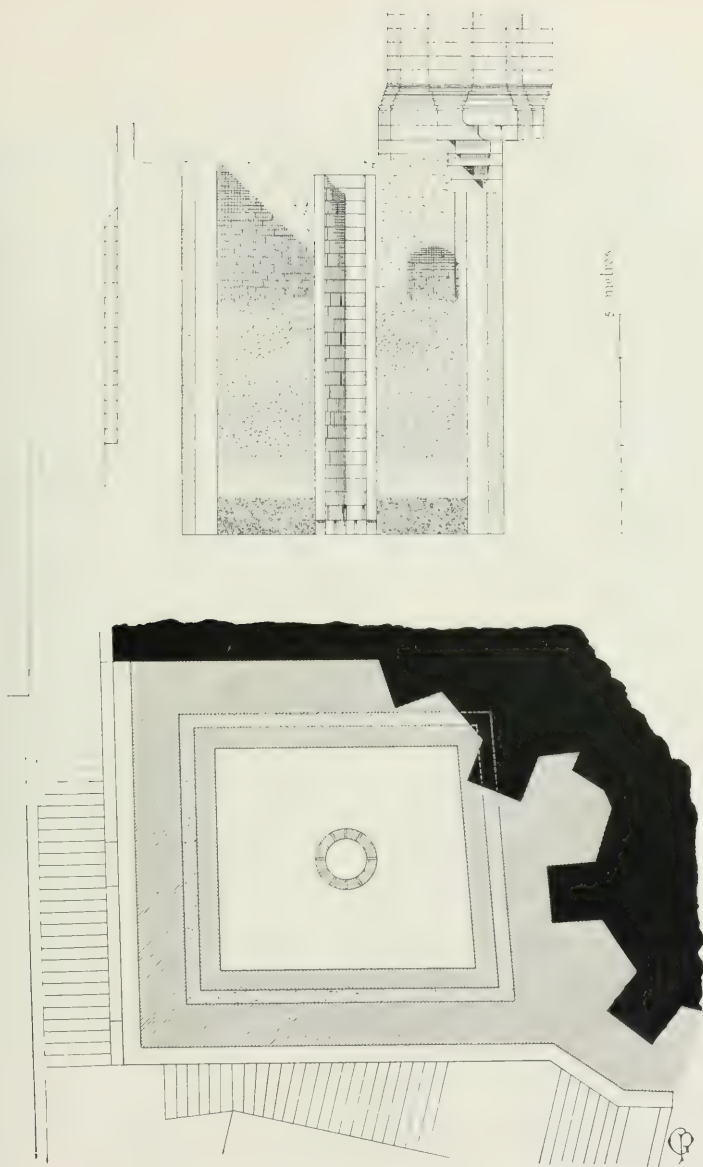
PLAN ET COUPE DE LA CHIERNE CONSTRUITE EN 1417.
